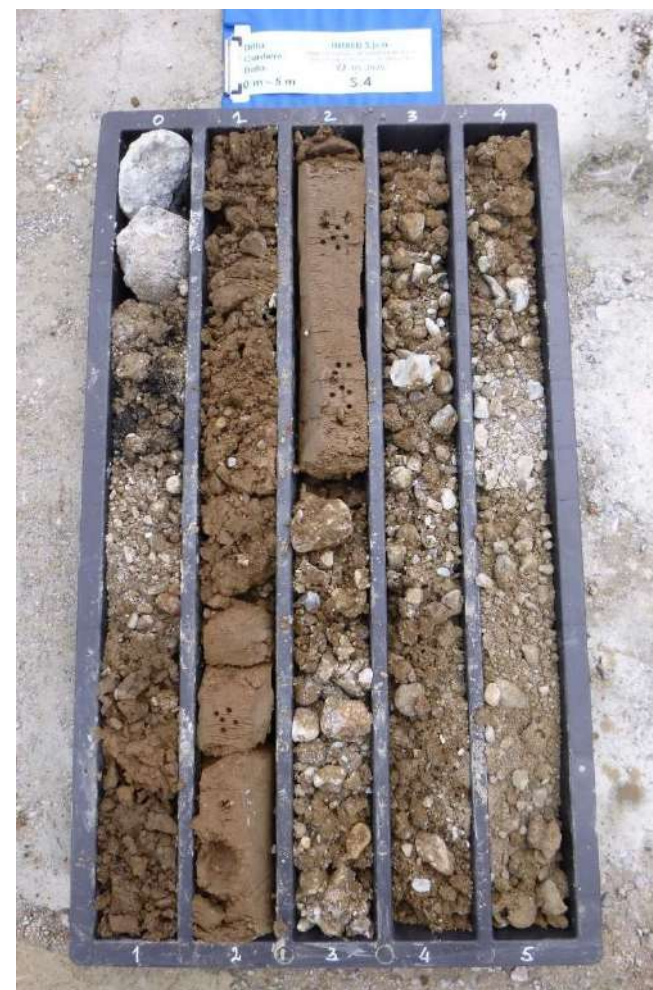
Sondaggio S.4 0,0 m – 5,0 m
